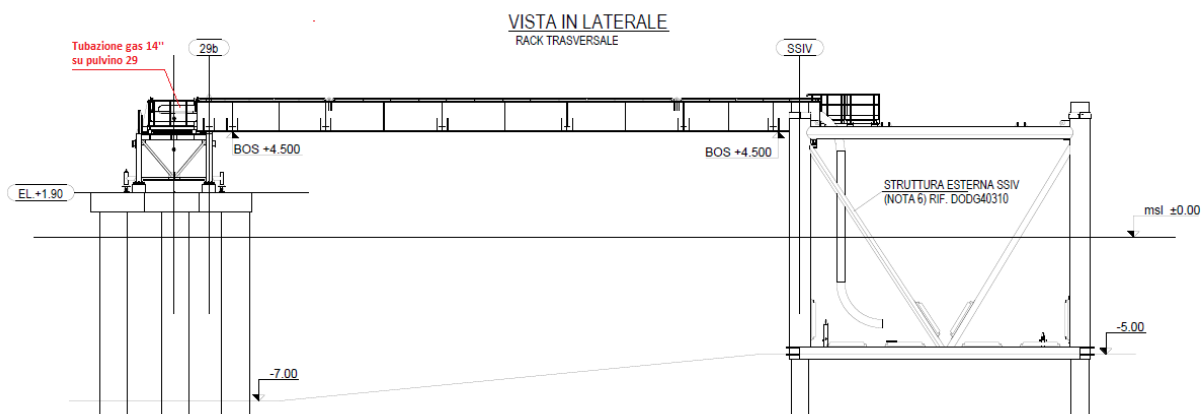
Installazioni definitive previste da progetto Cassiopea: modulo SSIV e passerella porta tubo su pulvino 29 trave tubo
